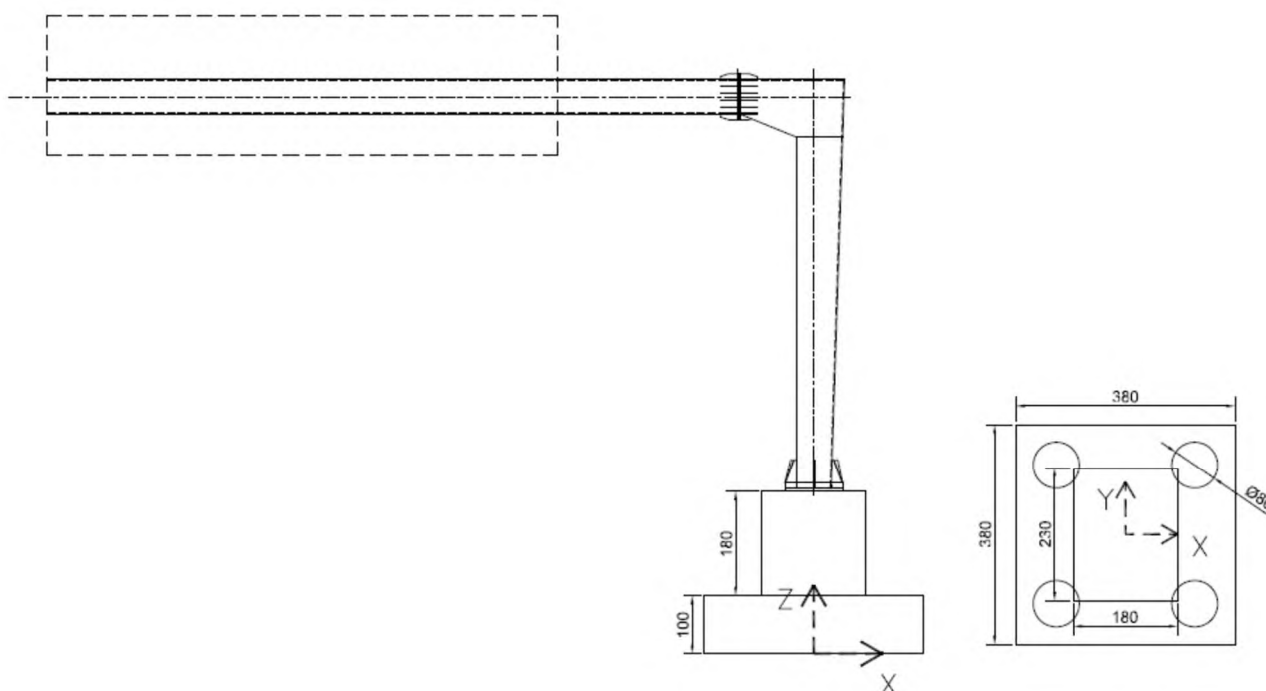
Carpenteria del plinto di fondazione - Posa su rilevato
